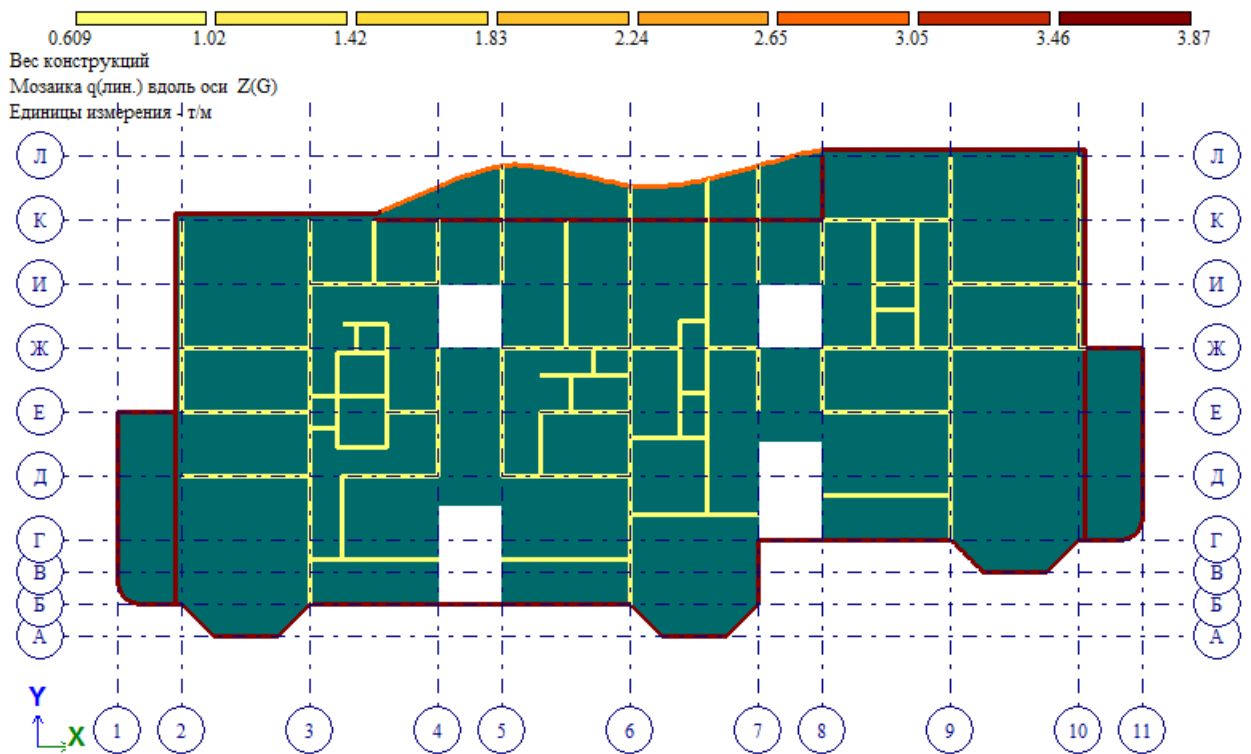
Загружение 1. Собственный вес конструкций. Нагрузки от стен и перегородок
